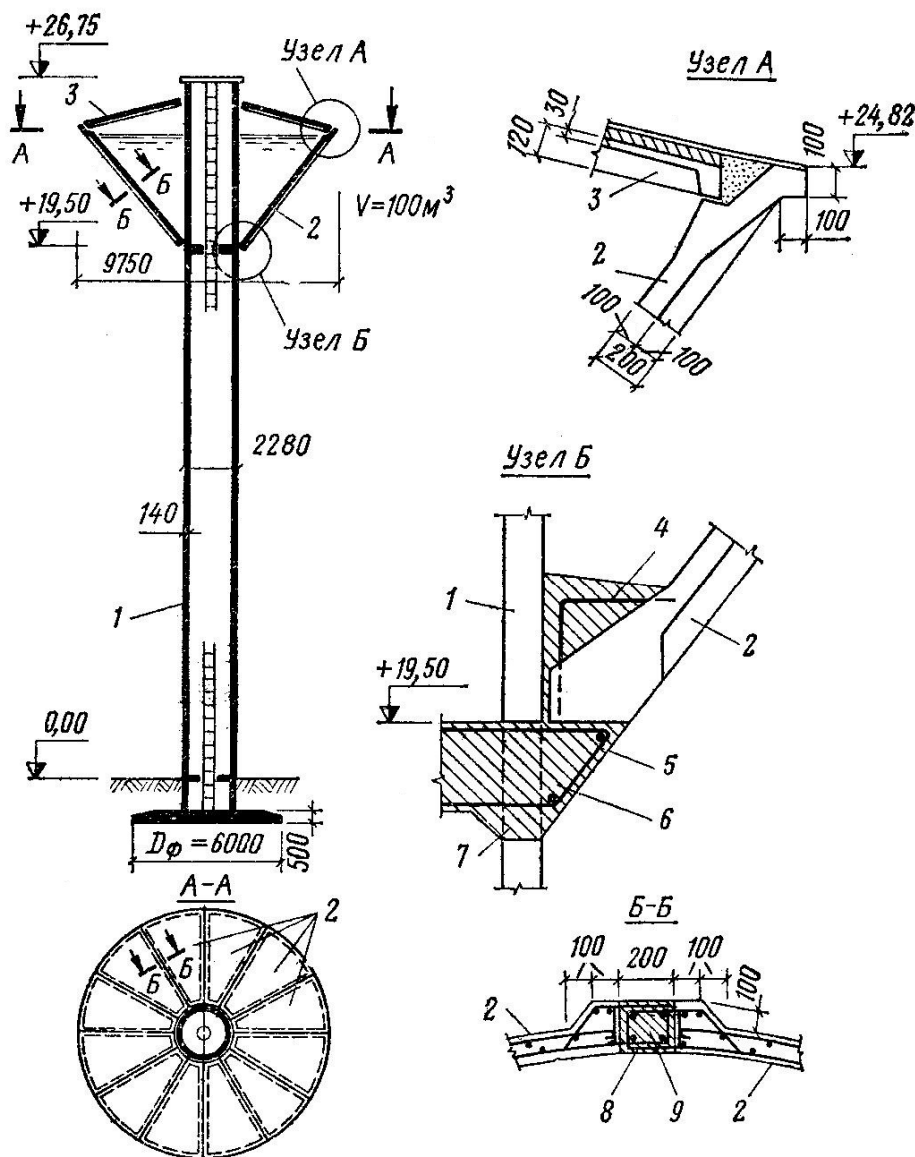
Водонапорная башня с резервуаром конической формы из сборного железобетона: 1 – опора из монолитного железобетона; 2 – сборные панели стенки резервуара; 3 – панели покрытия резервуара; 4 – выпуски арматуры из панели 2; 5 – арматура, устанавливаемая в окна в стенке опоры; 6 – часть опоры, бетонируемая после подъема резервуара; 7 – окна в стенке опоры; 8 – петлевые выпуски арматуры, шаг 200 мм; 9 – бетон марки С16/20
